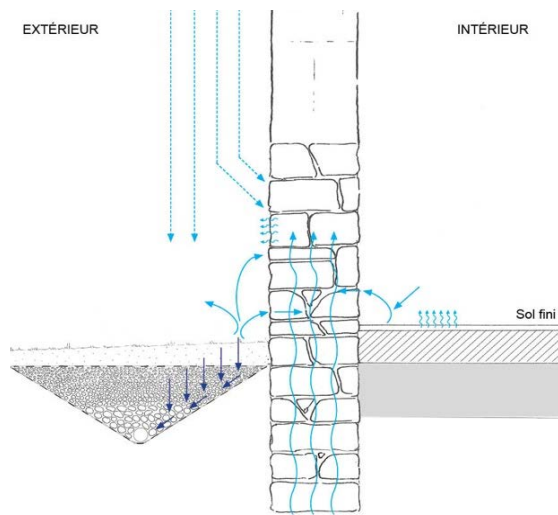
Fondation et soubassement\* en pierre, sol en terre enherbée en pente (10%) + drain\* enterré
